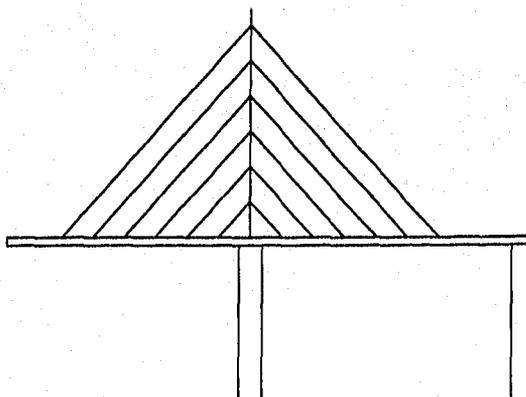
Arreglo Tipo Arpa o Paralelo
